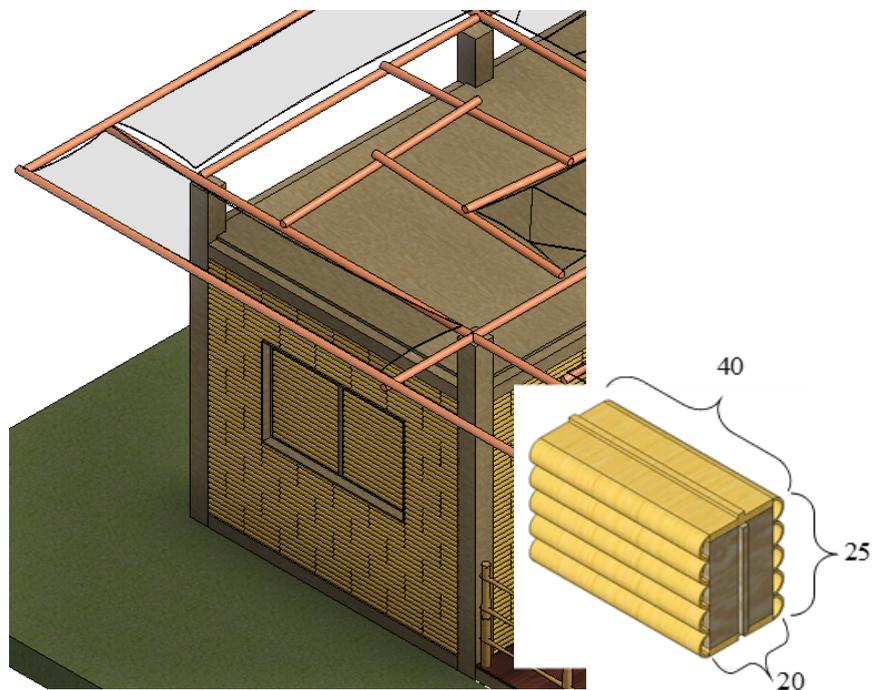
Detalhe tridimensional do fechamento das paredes externas do abrigo com detalhamento do maior bloco. Fonte: Elaborado pelas autoras (2025).
